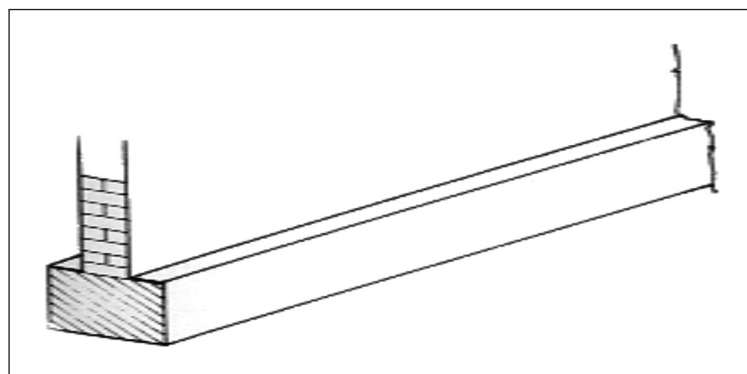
VIGAS DE CIMENTACIÓN EN PILAS.
